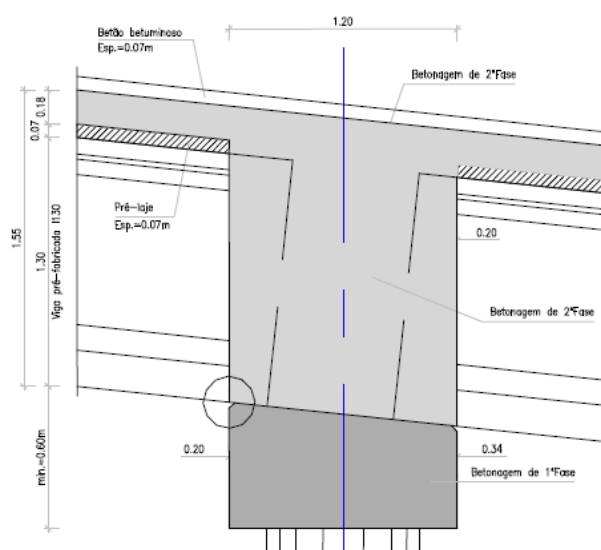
Projeto PS2 Lote 3 – pormenor da cabeça do pilar
